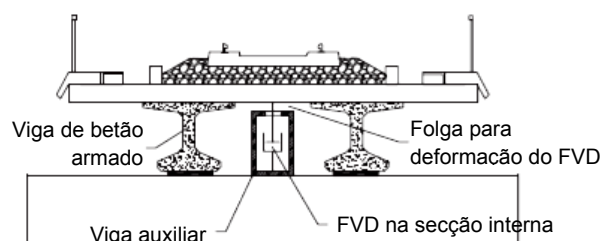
Configuração do sistema de amortecimento FVD para uma ponte de betão armado vigada (Fonte: Museros *et al.*, 2007)
